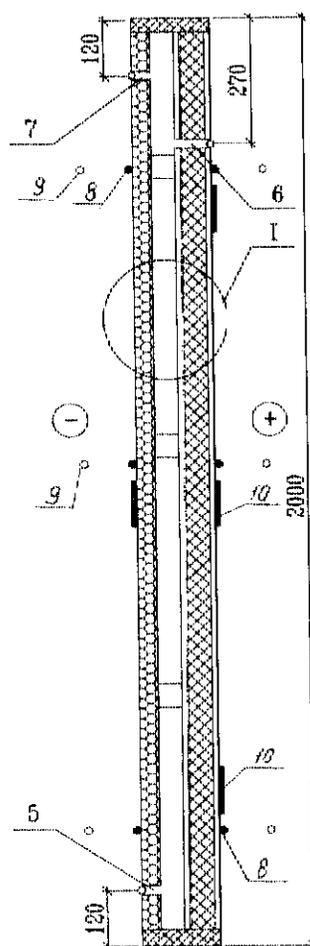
Фрагмент конструкции наружных стен с вентиляционными устройствами и расстановка термометрии
